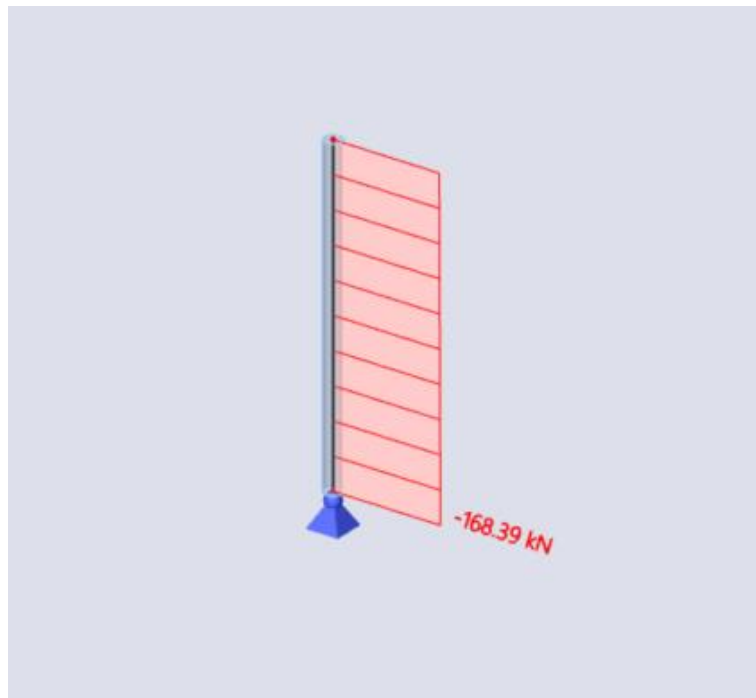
Uzdužna sila u armiranobetonskim stupovima prizemlja
